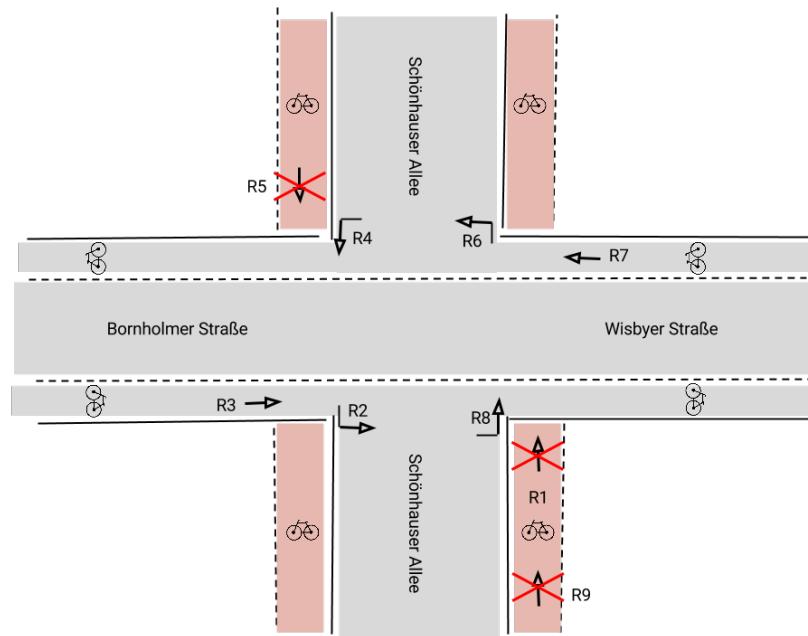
Lageplan Schönhäuser Allee/Wisbyer Straße
